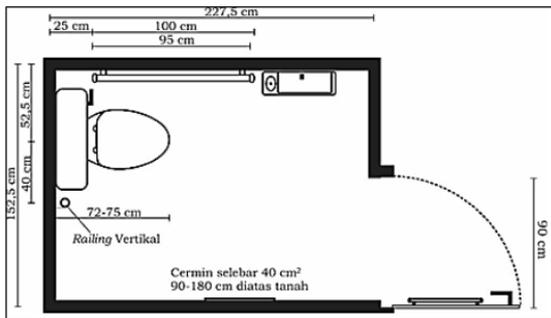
Lebar Efektif pintu serta ruang bebas didalam ruangan
